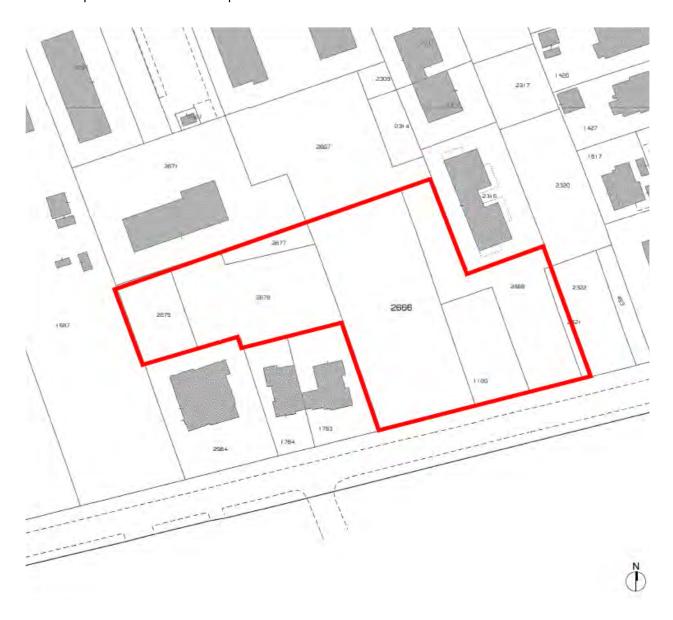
Stralcio planimetria catastale parcheggio Viale Milazzo – scala 1:1000
